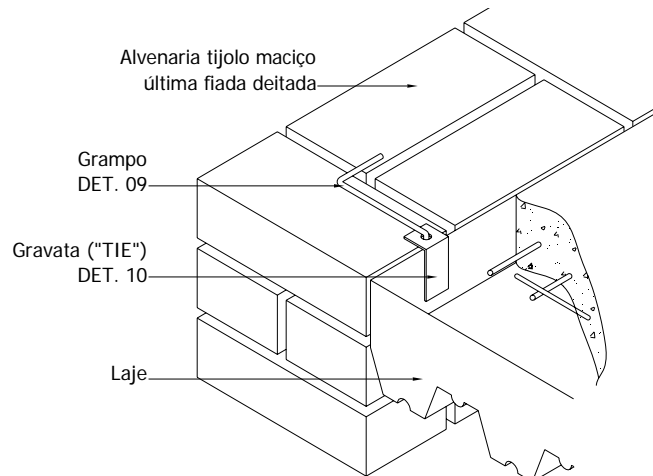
Detalhe de instalação do dispositivo de conexão entre a alvenaria e a laje.
